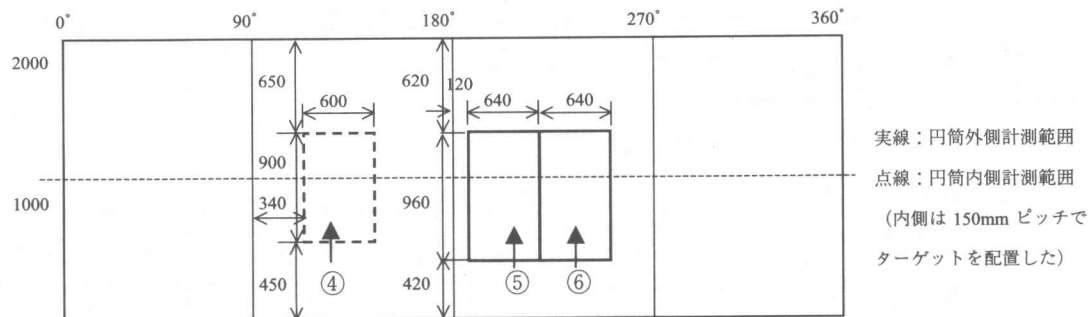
No.1 試験体計測範囲 (展開図: 単位 mm)
